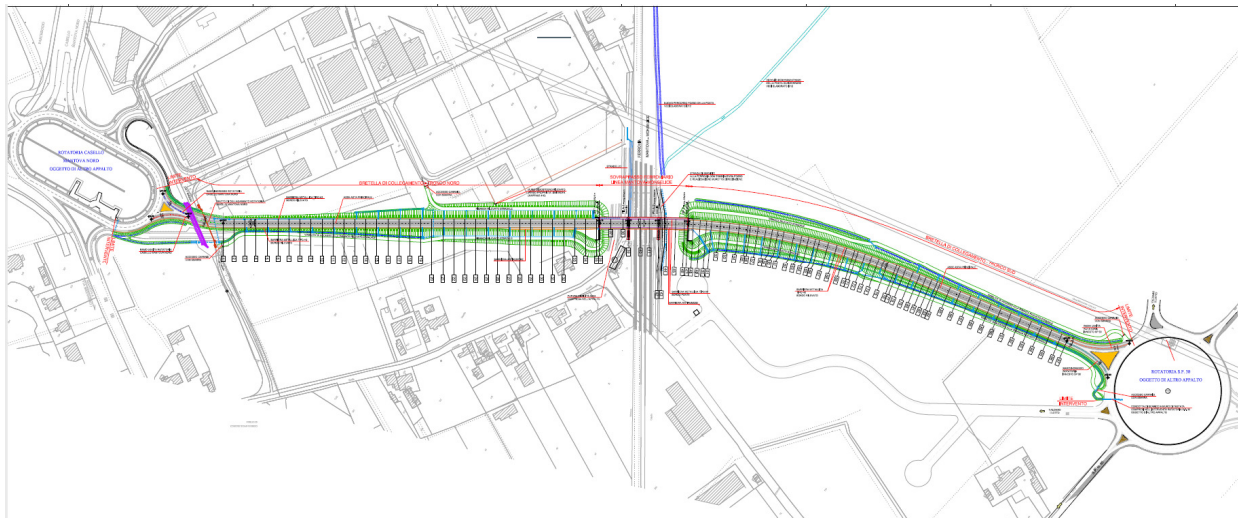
Estratto dalla planimetria generale di progetto - <https://www.provincia.mantova.it/>
